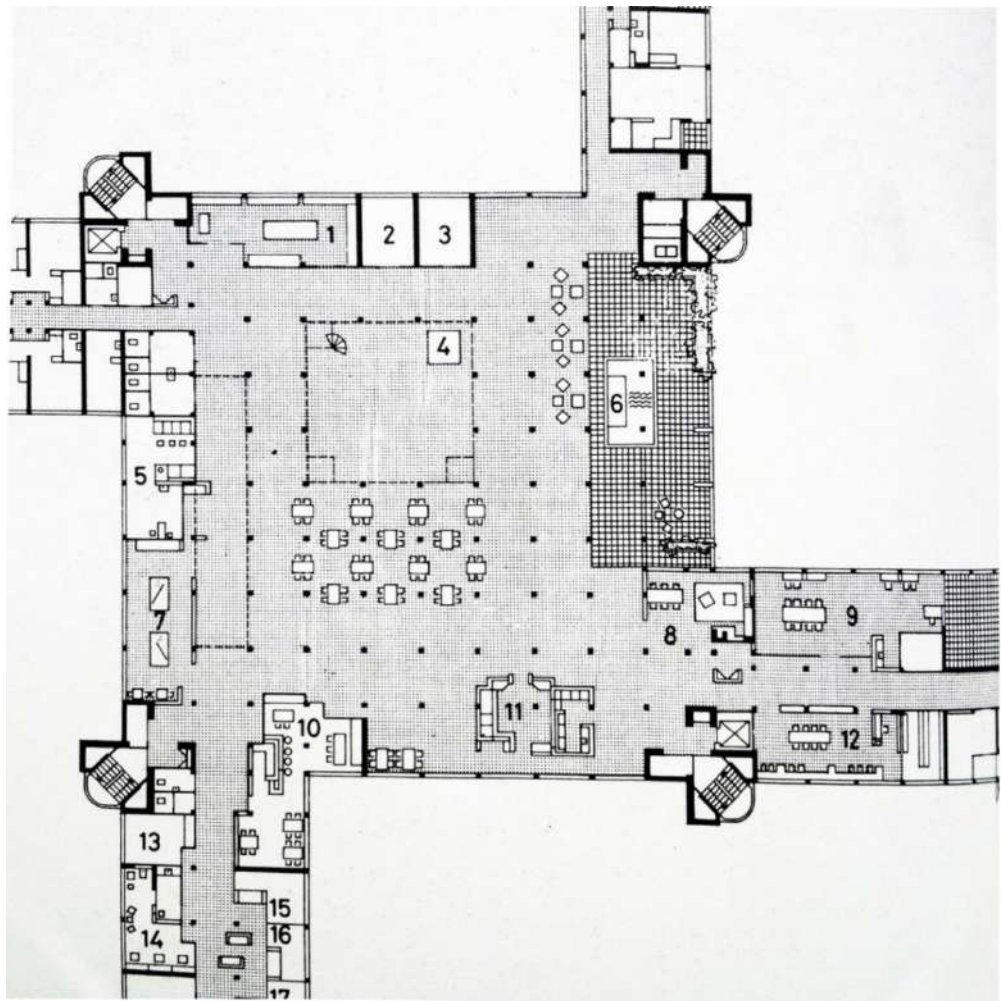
Plano del espacio central. Fuente: Sánchez, P.
